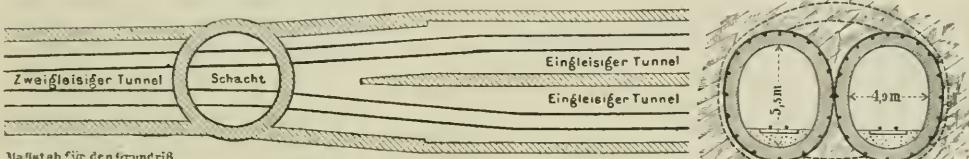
Grundriss des alten Hudsontunnels am New Jersey-Ufer.
